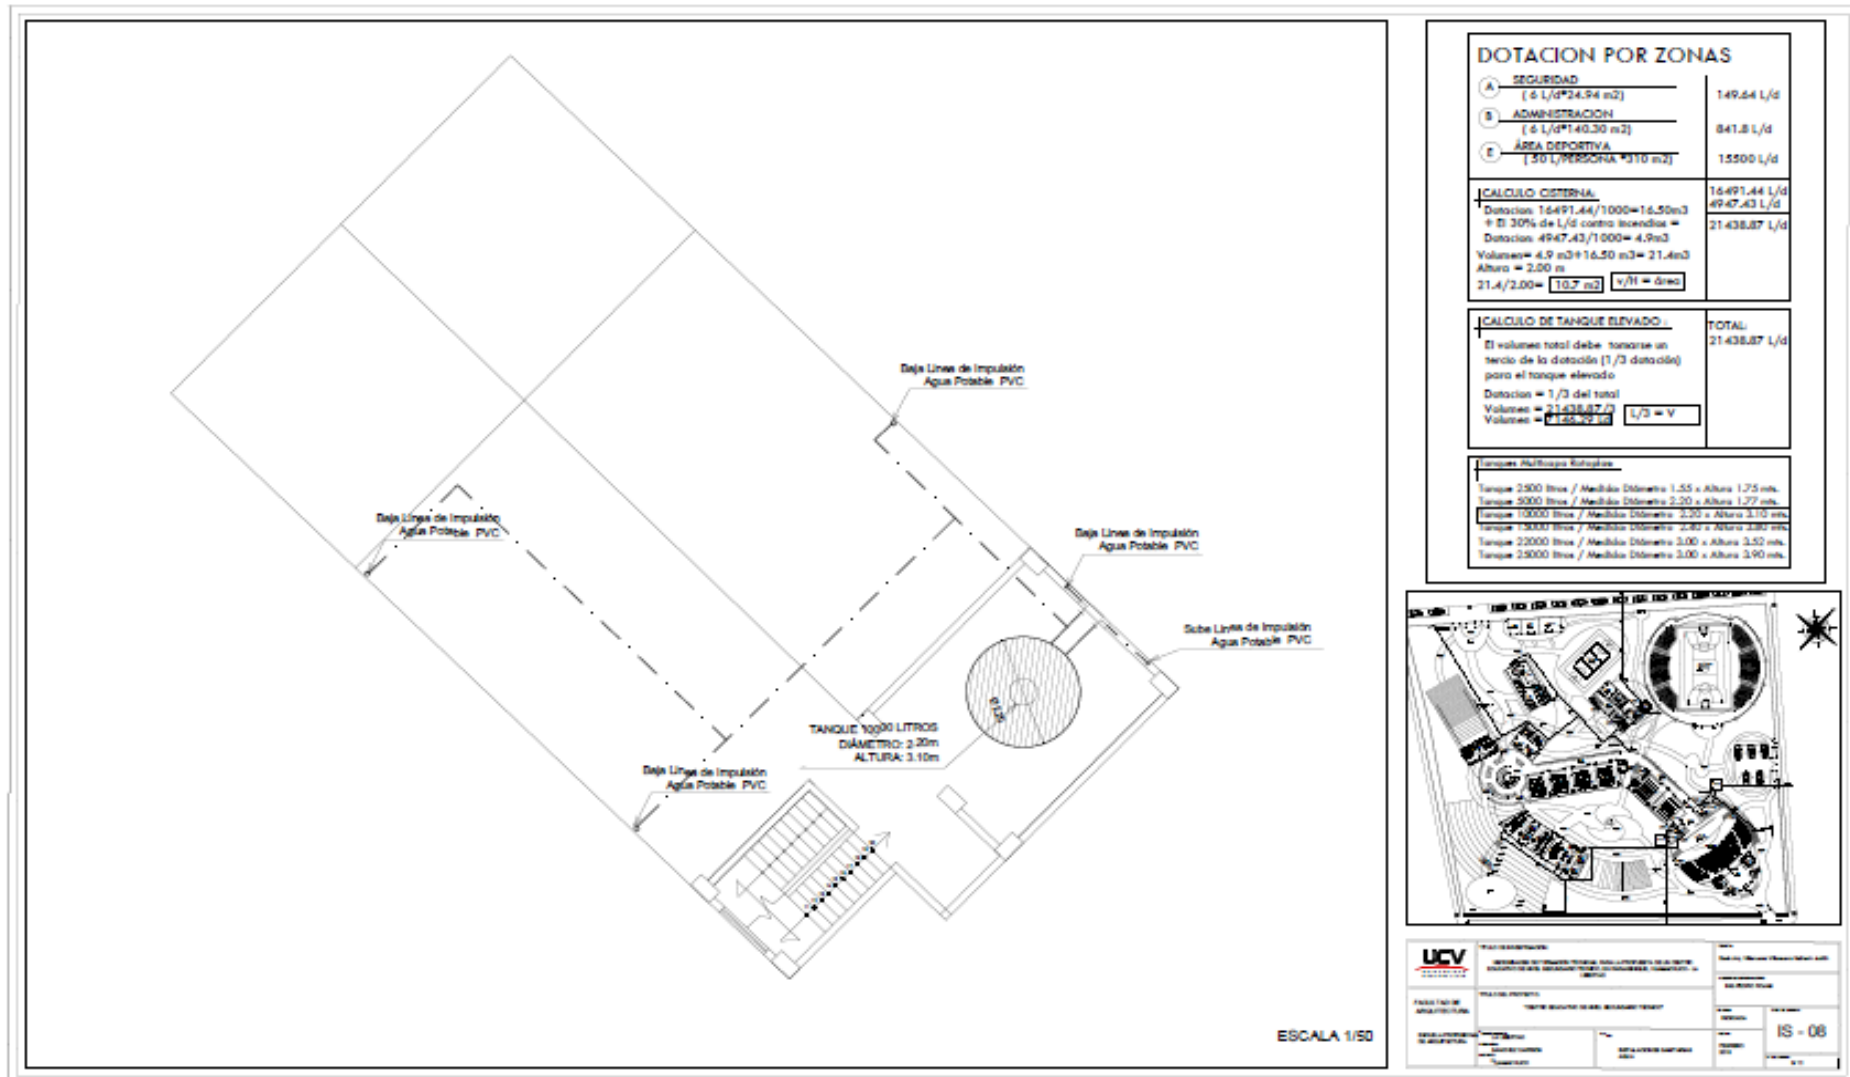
Plano de Diseño de Instalaciones Básicas Detalle – Agua - Plano N° 29 - Lamina IS-09
